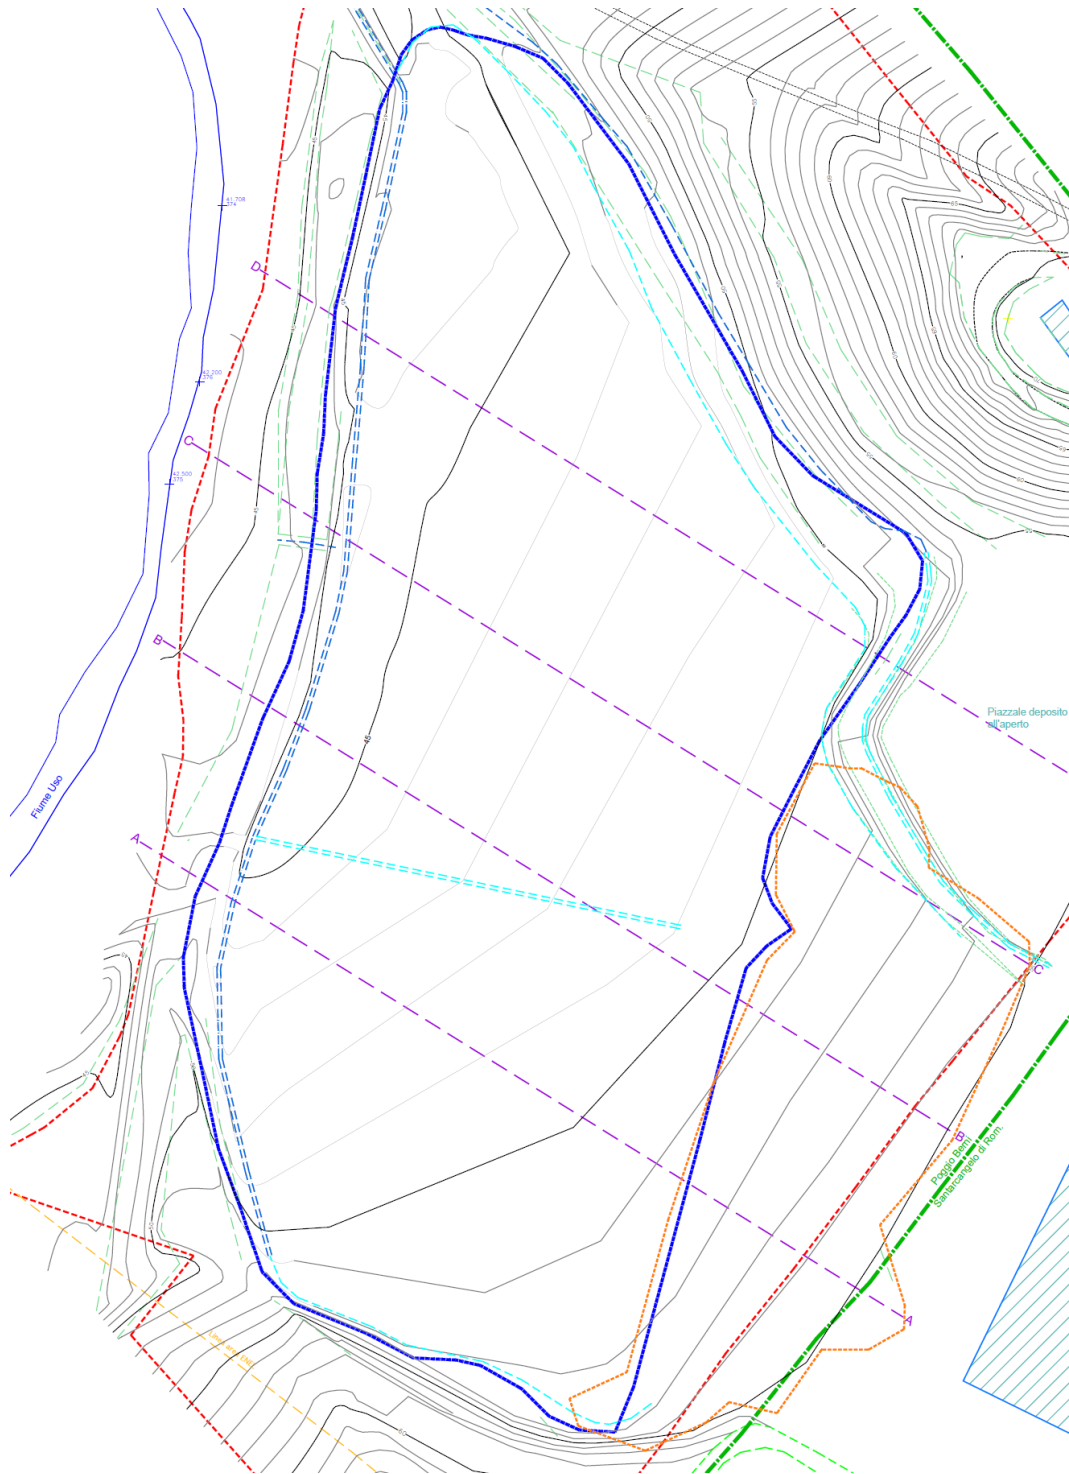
stralcio della tavola 5 planimetria di progetto al termine delle attività di sistemazione morfologica. Il progetto propone la rimozione dei cumuli di materiali in deposito, il loro utilizzo in ambito di cava per livellamenti e la riprofilatura del piano di base conferendo ad esso le opportune pendenze al fine di favorire lo scolo regolato delle acque meteoriche.
